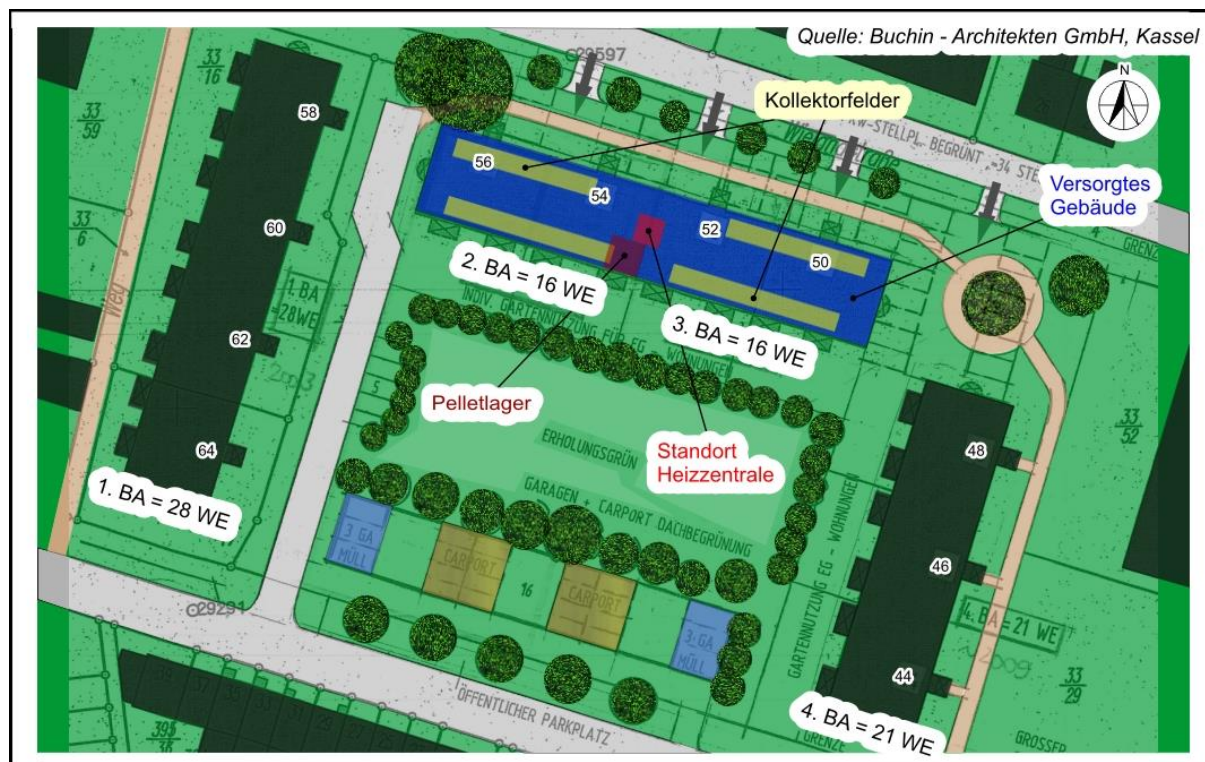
Lageplan Kassel, Brentanostraße 50 – 56
